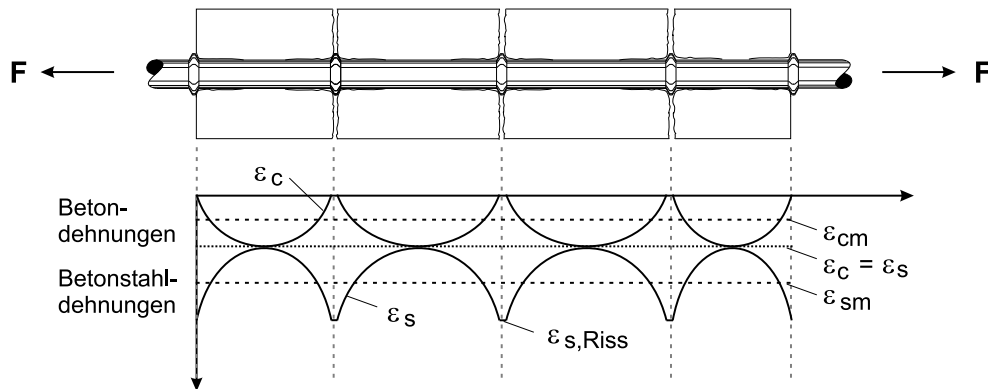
Betonzugstab (oben) und zugehörige Beton- und Betonstahldehnungen (unten) unter Last [40]
